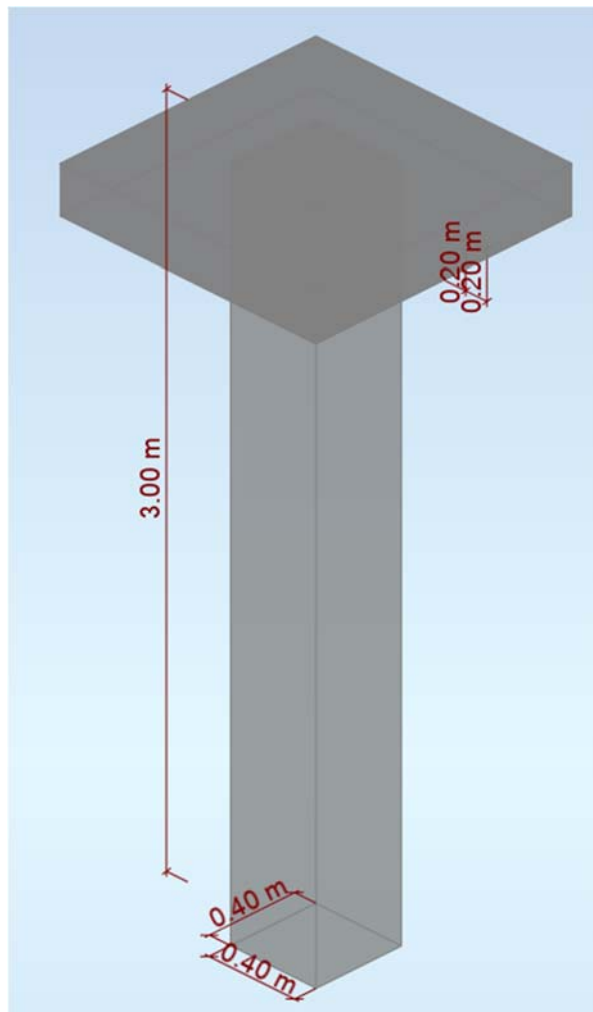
Розрахункова модель залізобетонної колони
